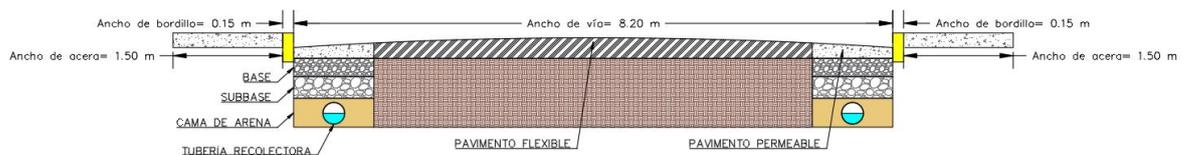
Sección tipo para Pavimento Mixto. Fuente: Diseño propio.
